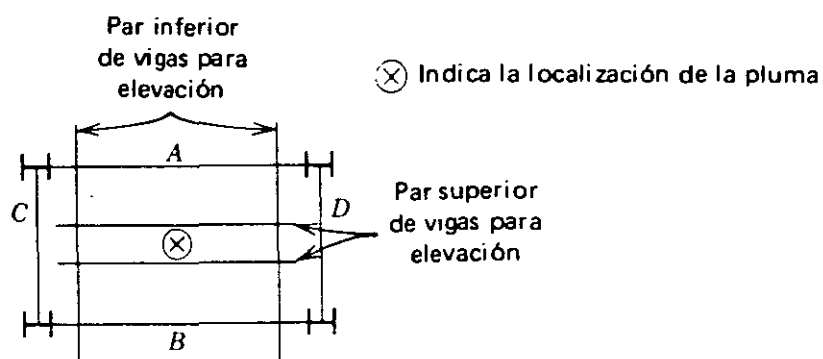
Colocación de las vigas para elevación. Las vigas A, B, C y D no son adecuadas por flexión pero sí por cortante cerca de las columnas.
